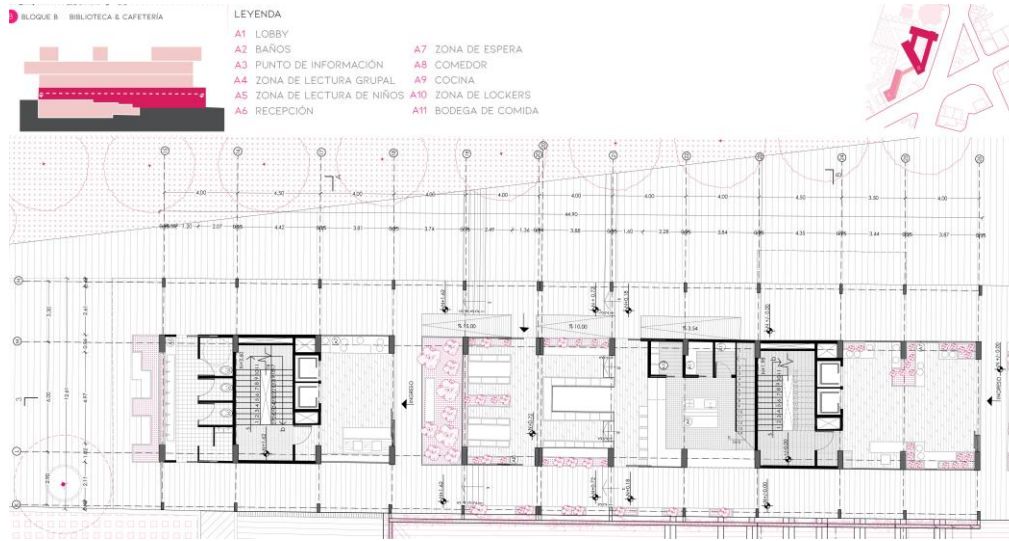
Planta Baja – Bloque B2. Fuente: (Andrade, 2019).
